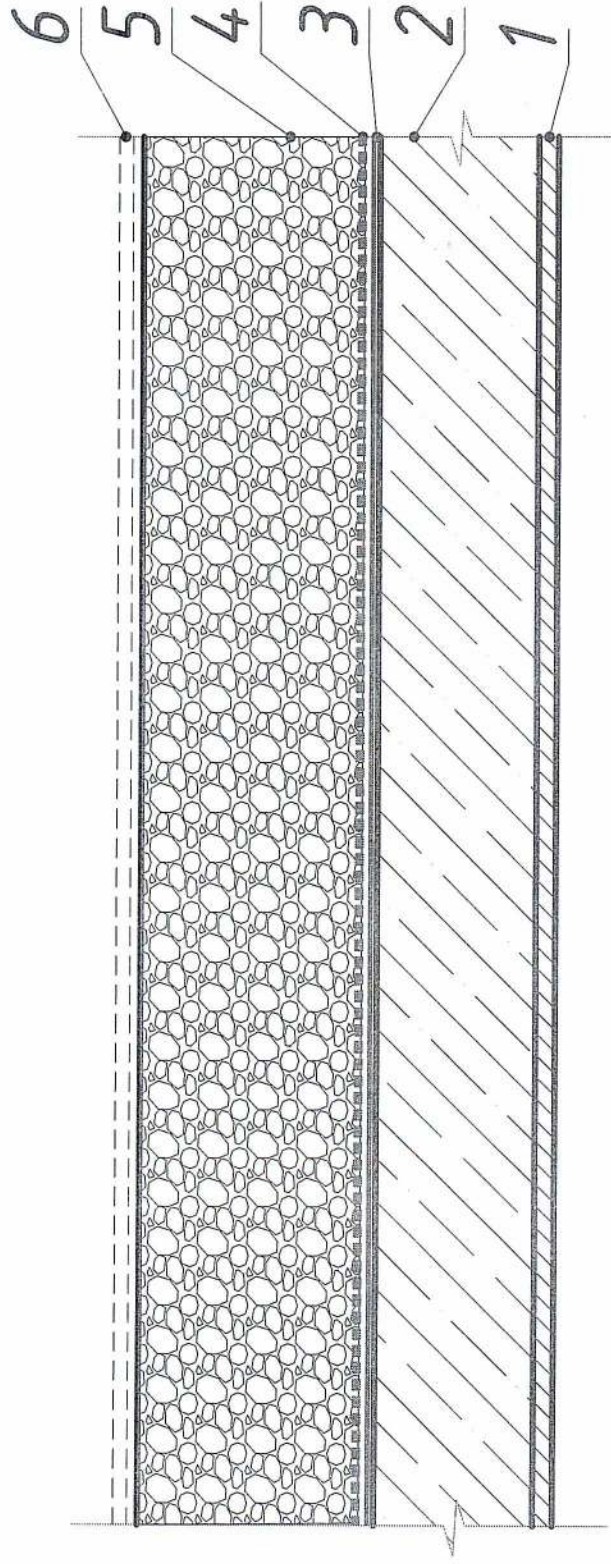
Принципиальная схема конструктивного исполнения чердачного перекрытия выполняемого по железобетонному основанию
